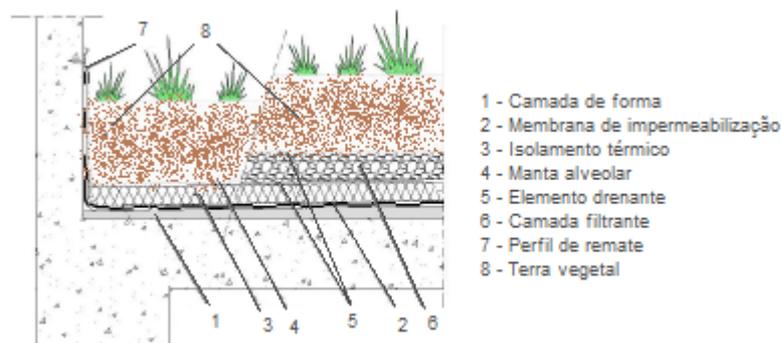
Impermeabilização de cobertura plana ajardinada (Aspim@ 2013)
